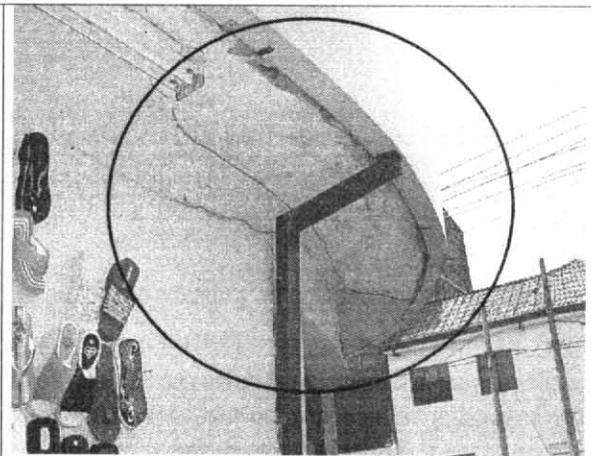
Condiciones de fachada sur, desprendimiento de pañete bajo la placa de voladizo.
